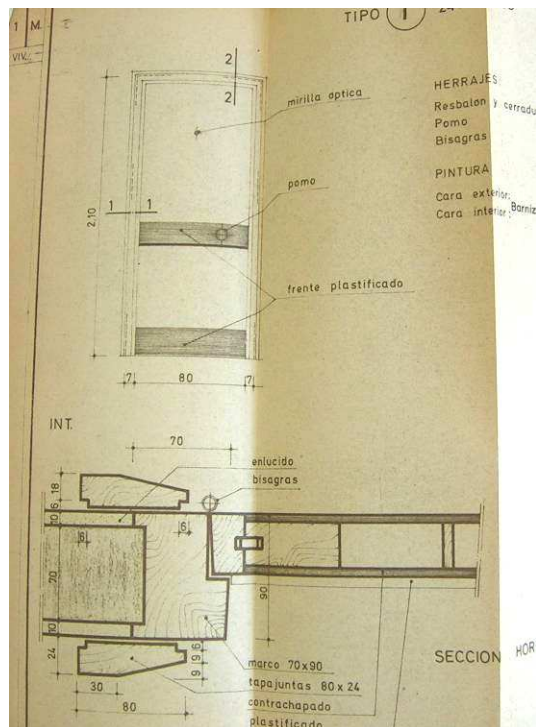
Detalle de carpintería de las puertas, Edificio ficha 215C.015, 1969.
